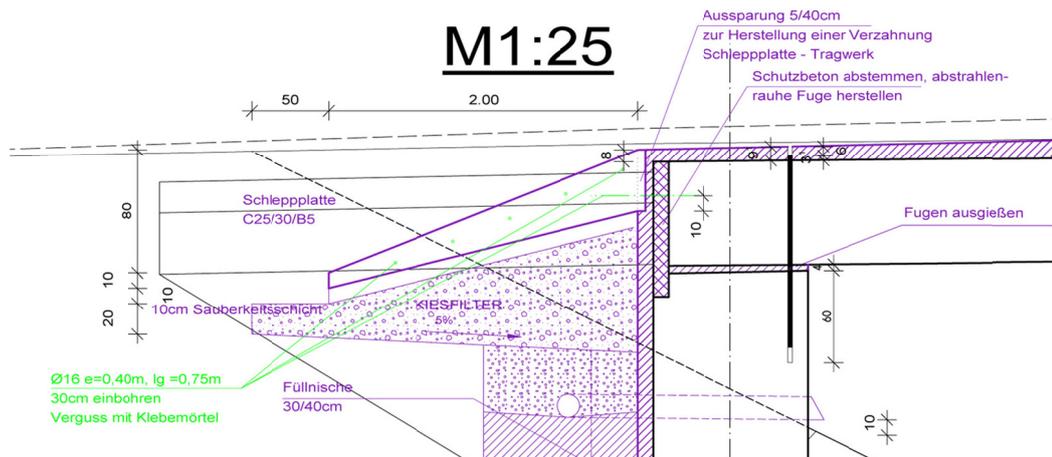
Detailausbildung Widerlagerbereich Objekt 16021 [53]
